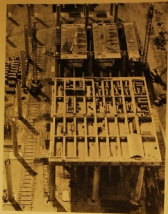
Vue en plan de débouché de la rampe au niveau 122,15.
